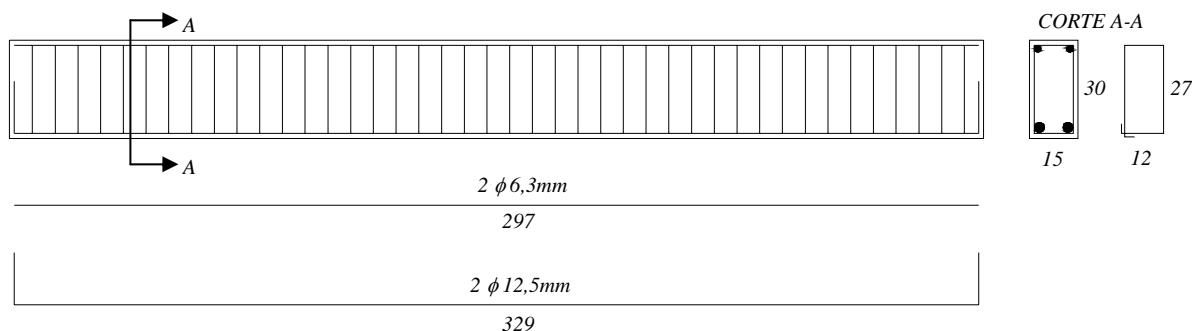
Detalhamento das vigas ensaiadas na primeira etapa.
